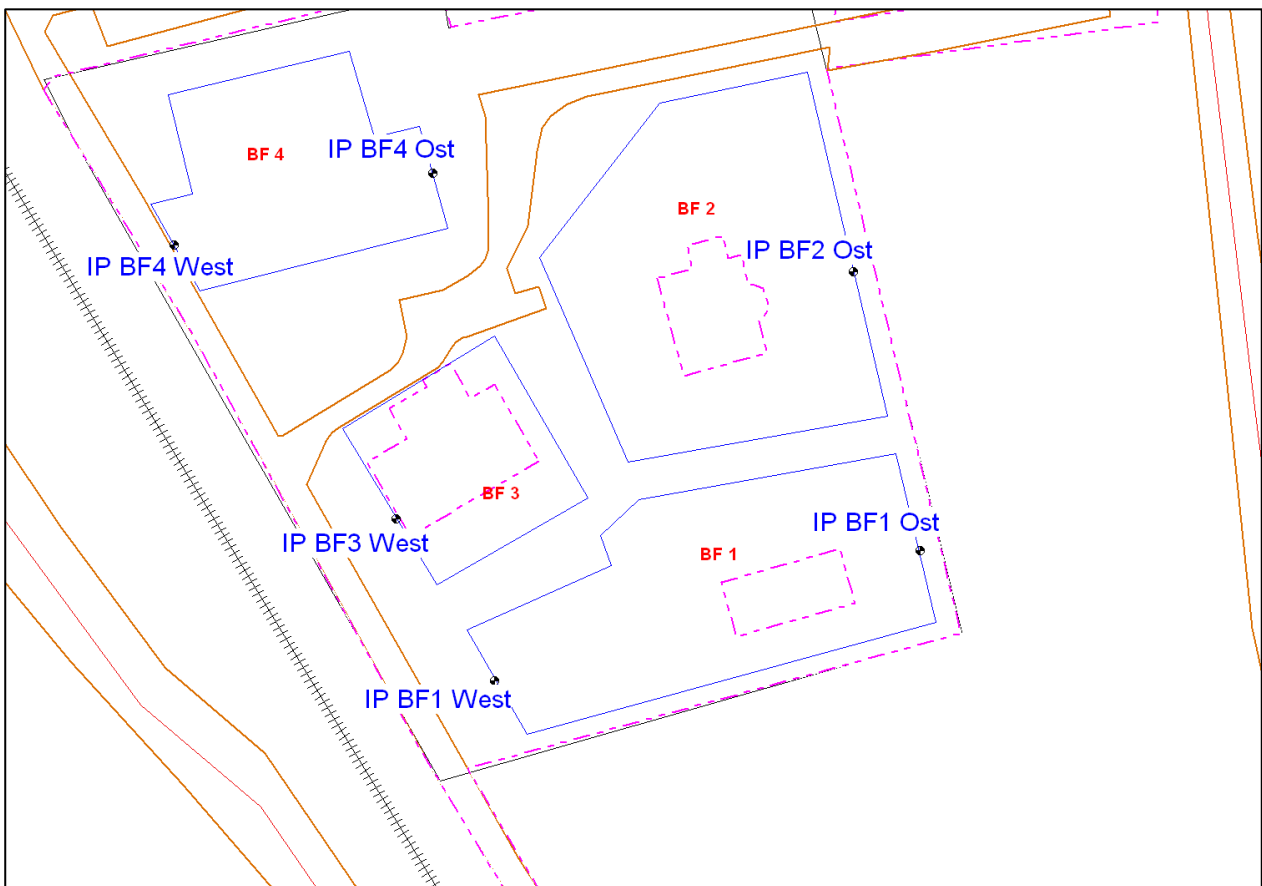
Lageplan der Baufelder des B-Plangebietes und die Lage der Immissionsorte IP
